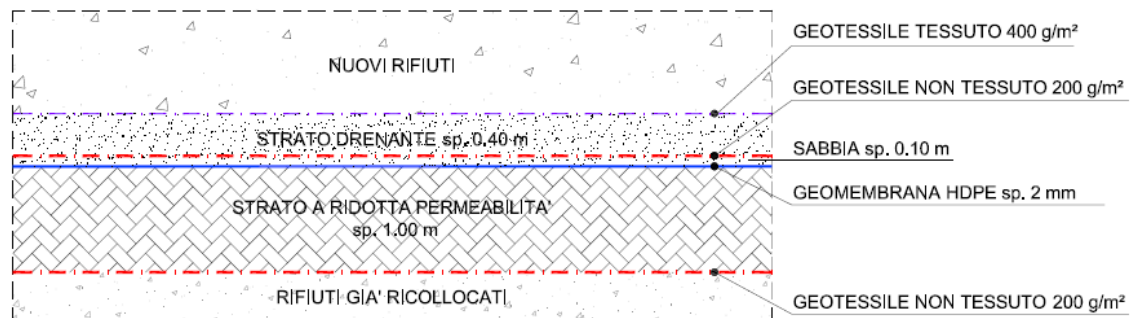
Schema di impermeabilizzazione del fondo.
